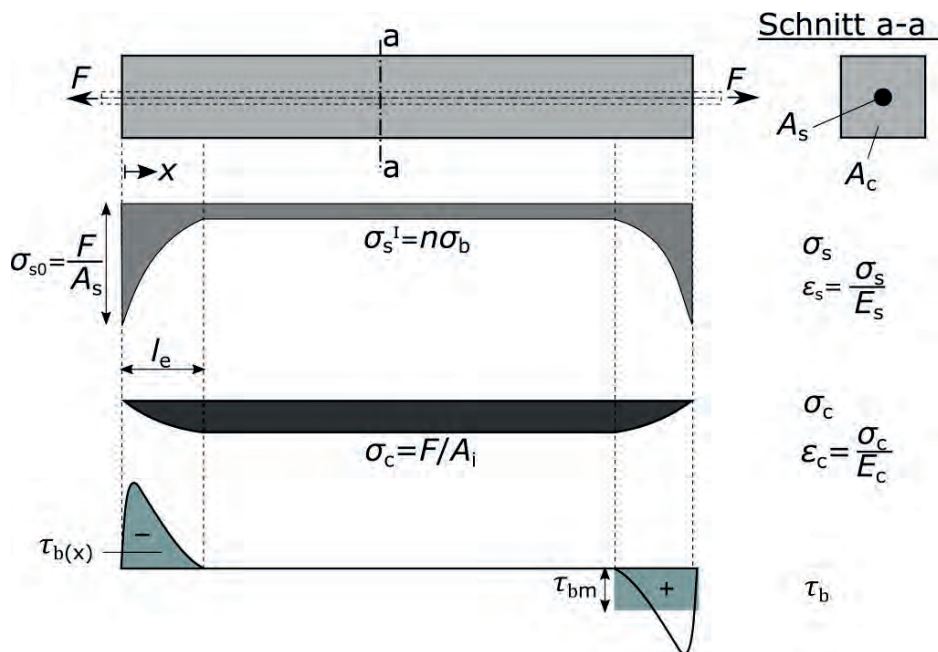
Stahlbetonprisma mit Zugstab im ungerissenen Zustand nach *Leonhardt 1984
